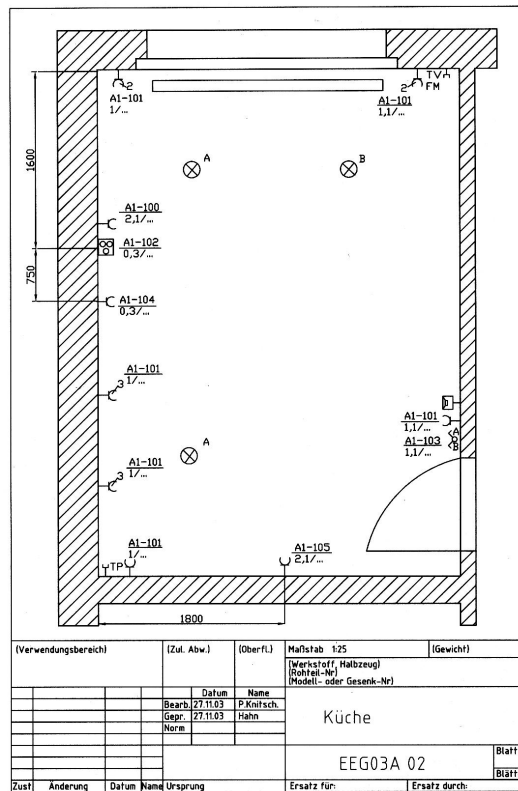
Modul E-Werkstatt - Grundriss der Küche
